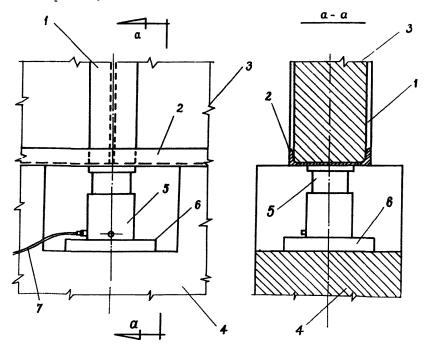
Схема устройства в каменный забирке домкратной ниши для подъема промежуточных стоек фахверка:
